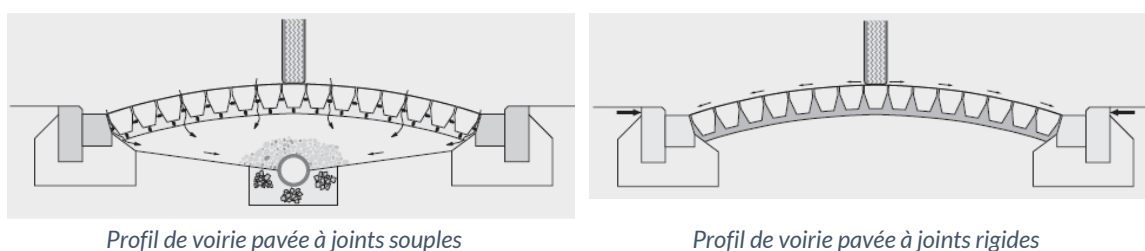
modification du type de joints d'une chaussée pavée¹¹²
